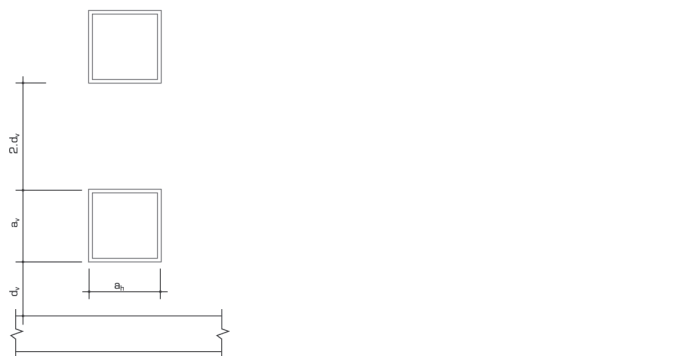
Ilustração de distribuição vertical de aberturas em uma parede de concreto
